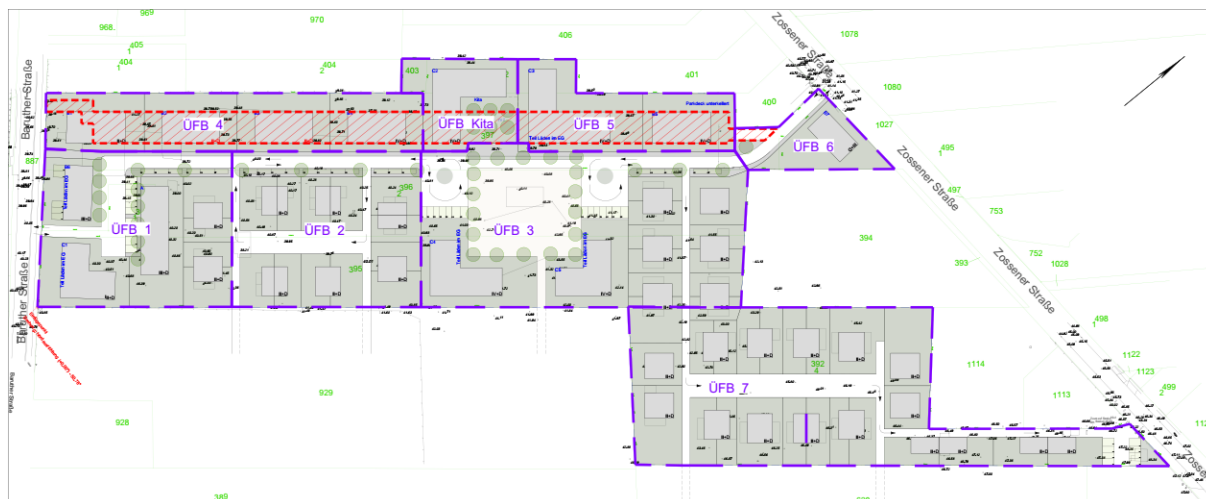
Ausschnitt Lageplan Überflutungsbetrachtung, HOFFMANN-LEICHTER (11/2024)
